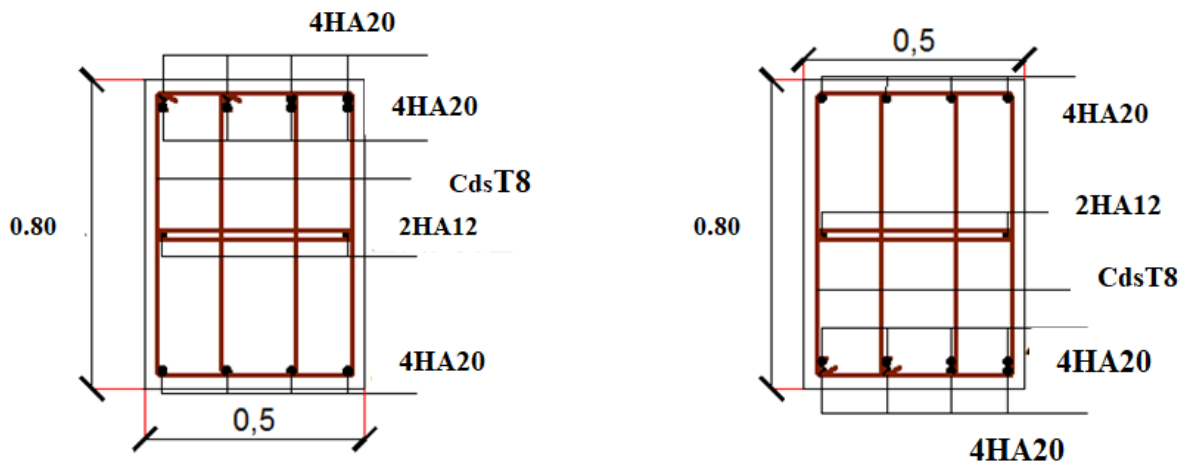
Ferrailage de la nervure en travées et en appuis
